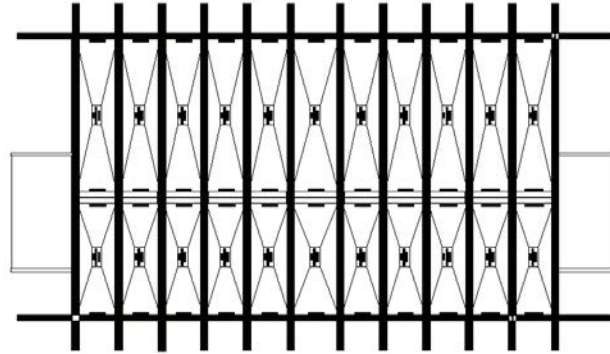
Vista de planta tipo torre A, disposición de los módulos Variel.
